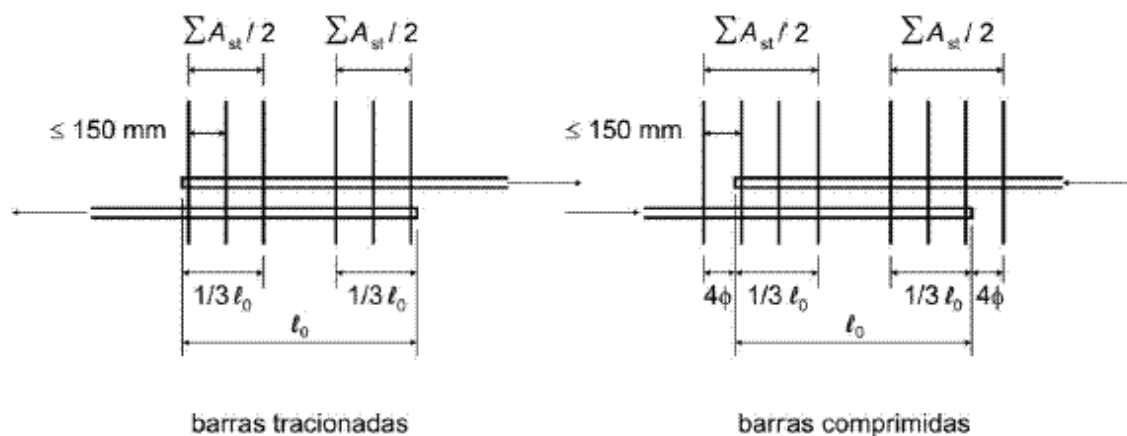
Disposição da armadura transversal nas emendas NBR 6118 – original de ABNT (2003).
